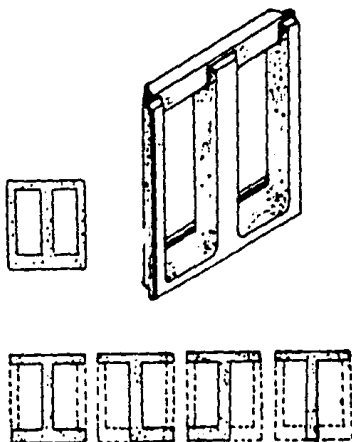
Aplicación típica del concepto de molde patrón.
